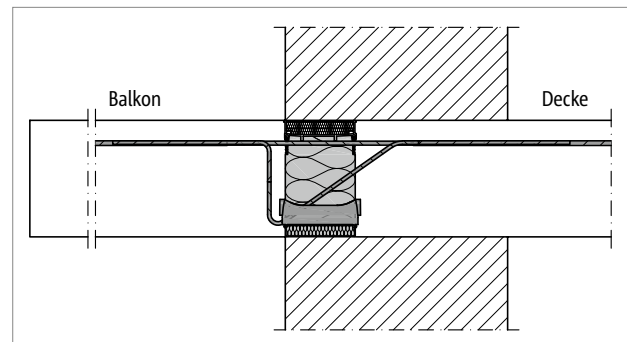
Schöck Isokorb® XT Typ K: Anschluss bei einschaligem Mauerwerk
